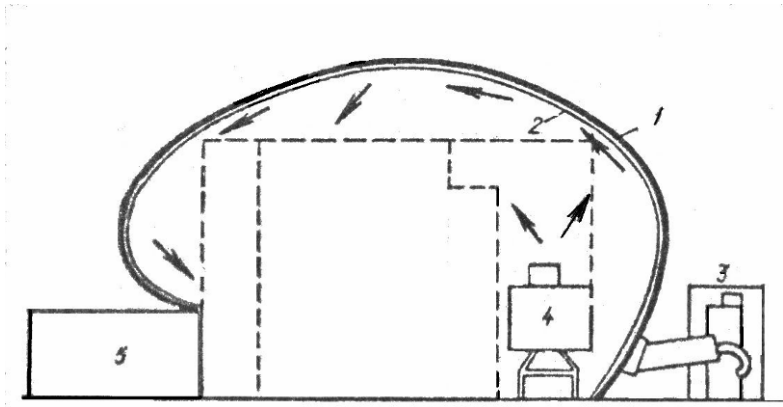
Схема надувної конструкції сховища із РГС:
